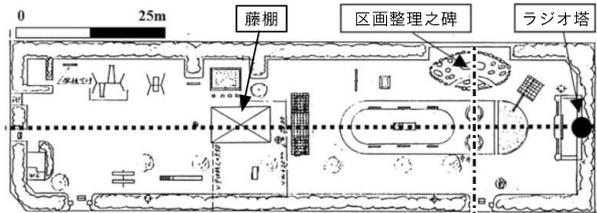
北区紫野柳児童公園の平面図(京都市所蔵の平面図に筆者加筆)
